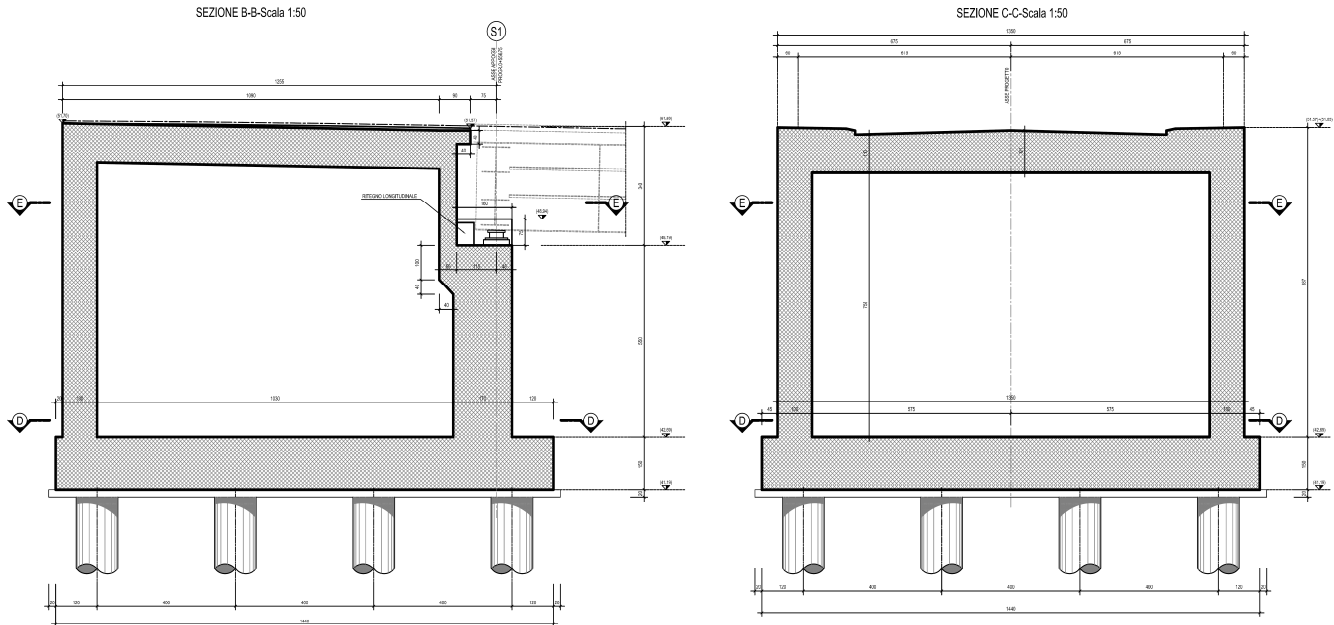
Sezioni longitudinale e trasversale spalla S1
